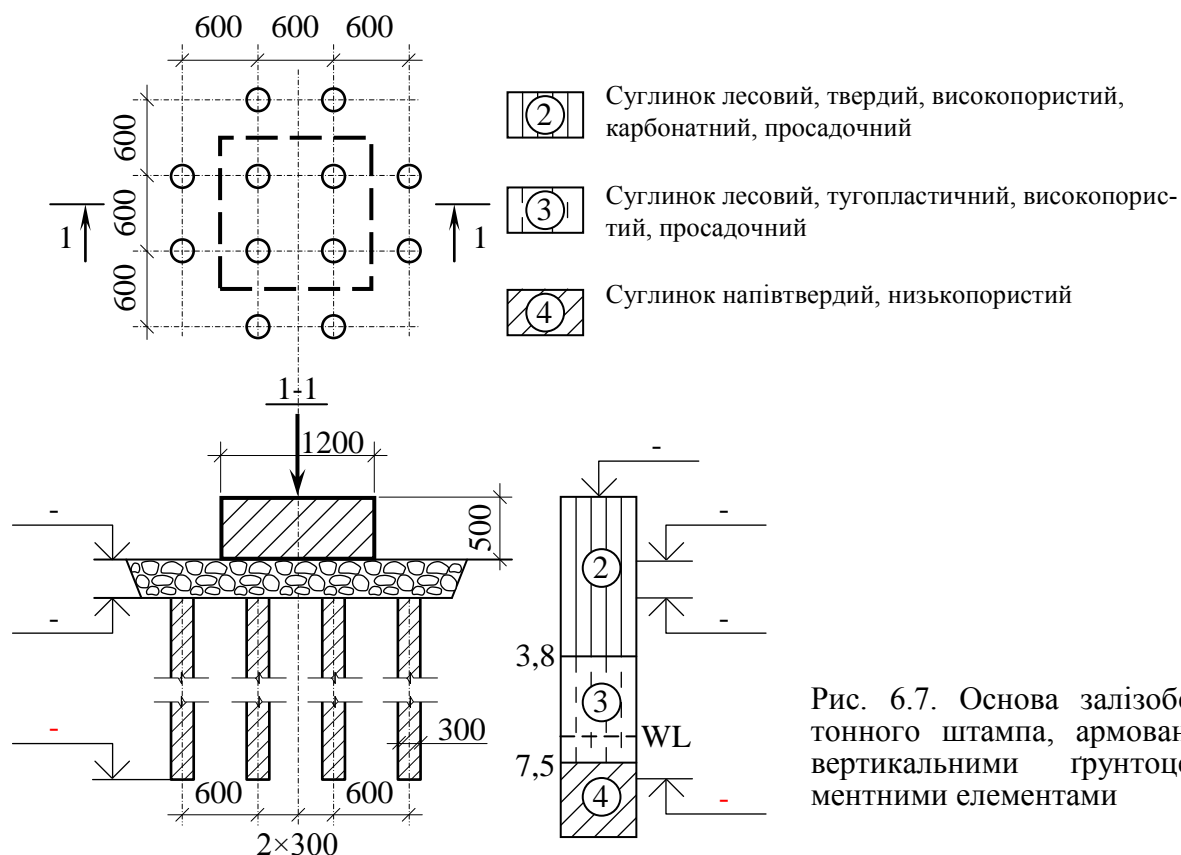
Основа залізобетонного штампа, армована вертикальними ґрунтоцементними елементами
